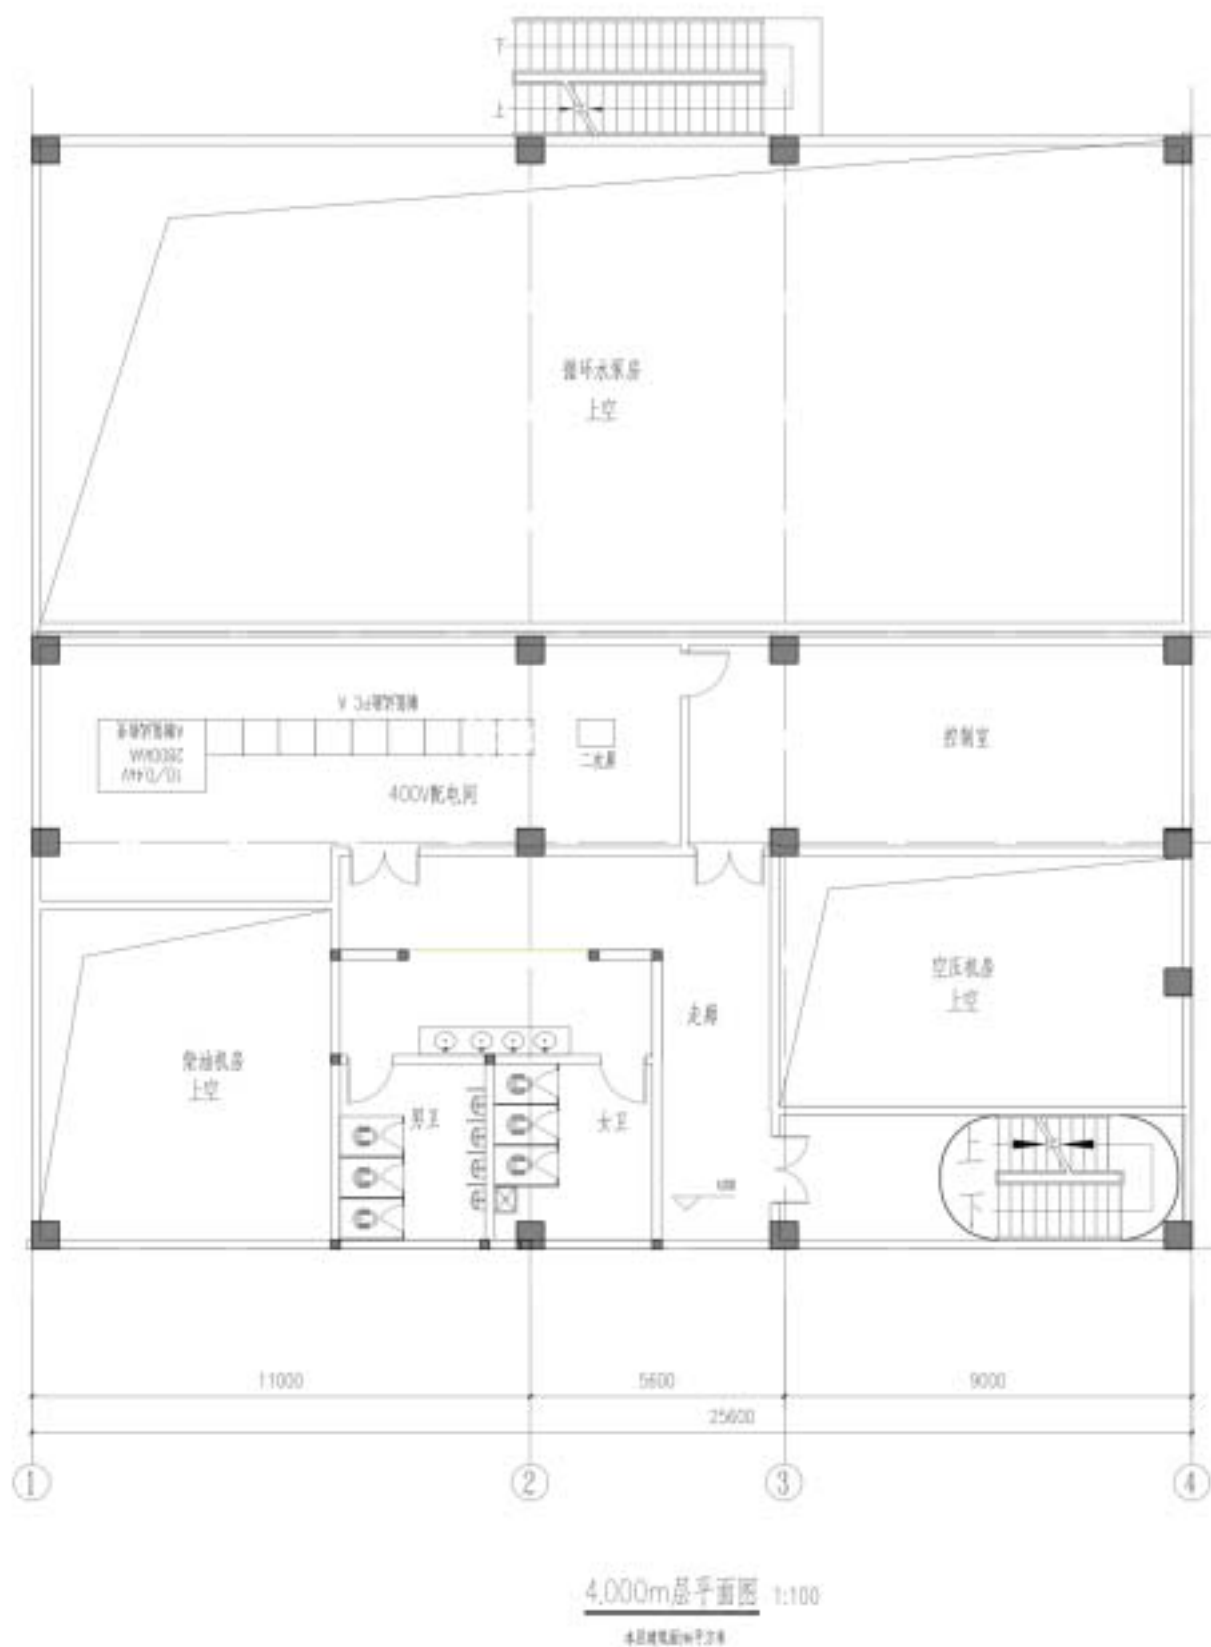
辅助生产楼 4.000m 层平面布置示意图
